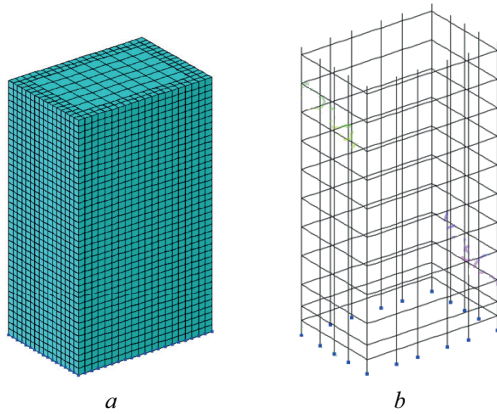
Общий вид (а) и схема армирования (б) расчетной модели столбчатого фундамента МНЛЗ
